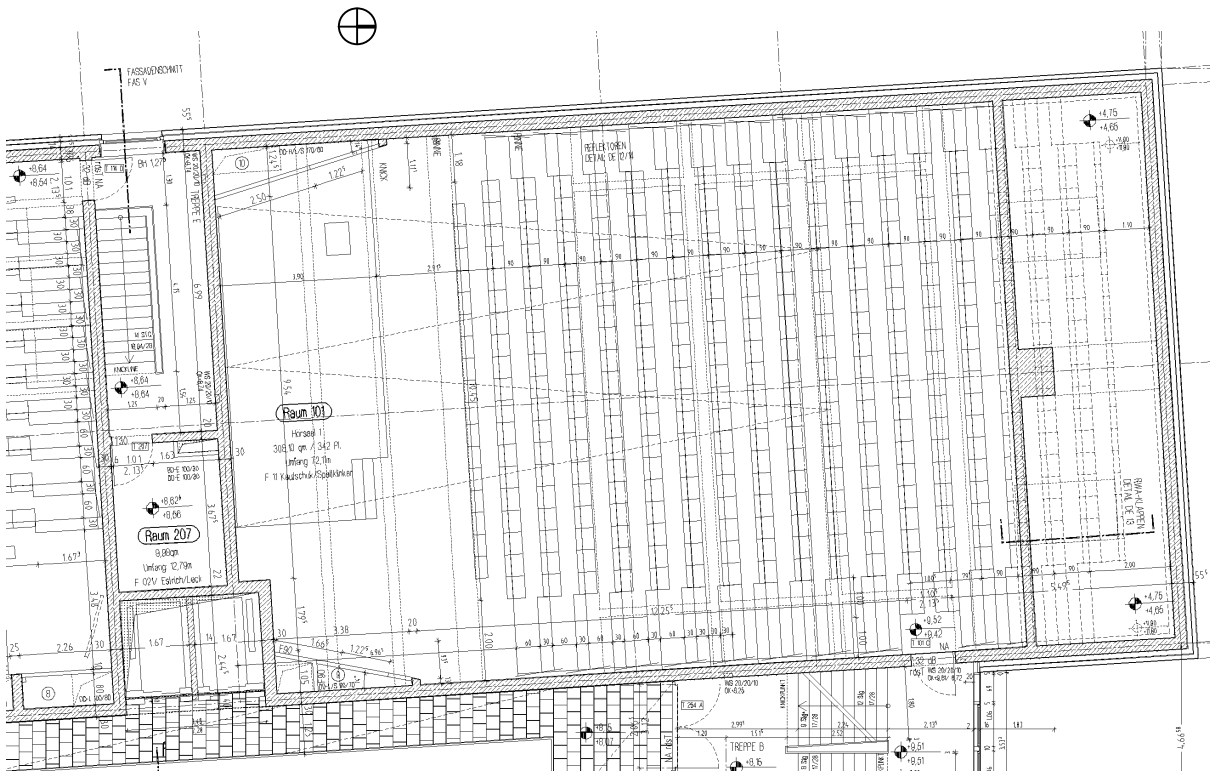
Grundriss (Maßstab ca. 1:200)
